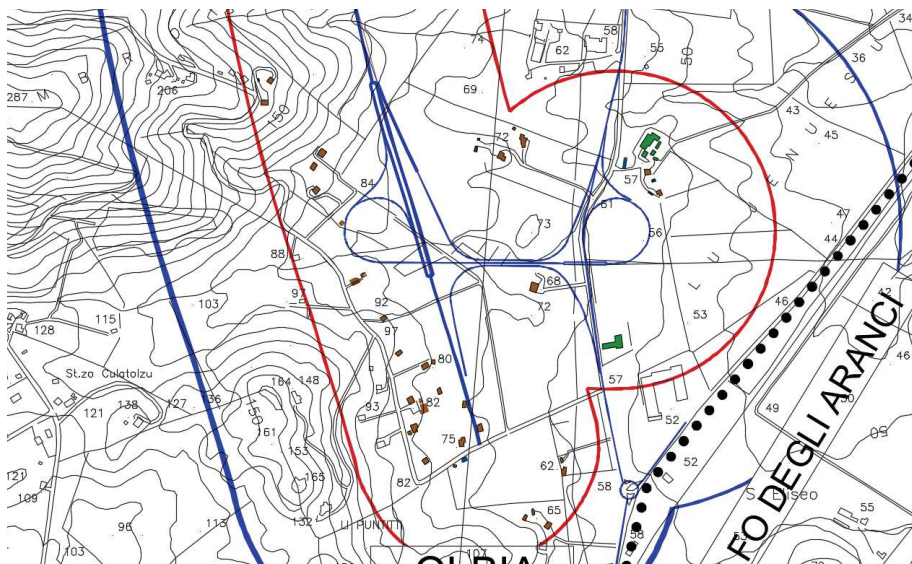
Stralcio planimetria dei ricettori e fasce acustiche PP 2003
